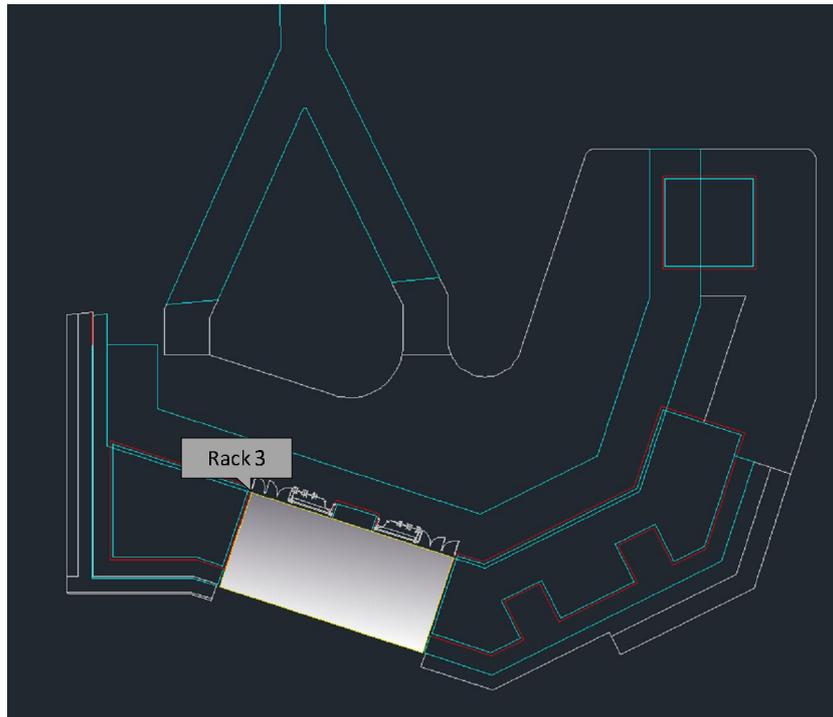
Ubicación Racks Bioparc (Acceso)
